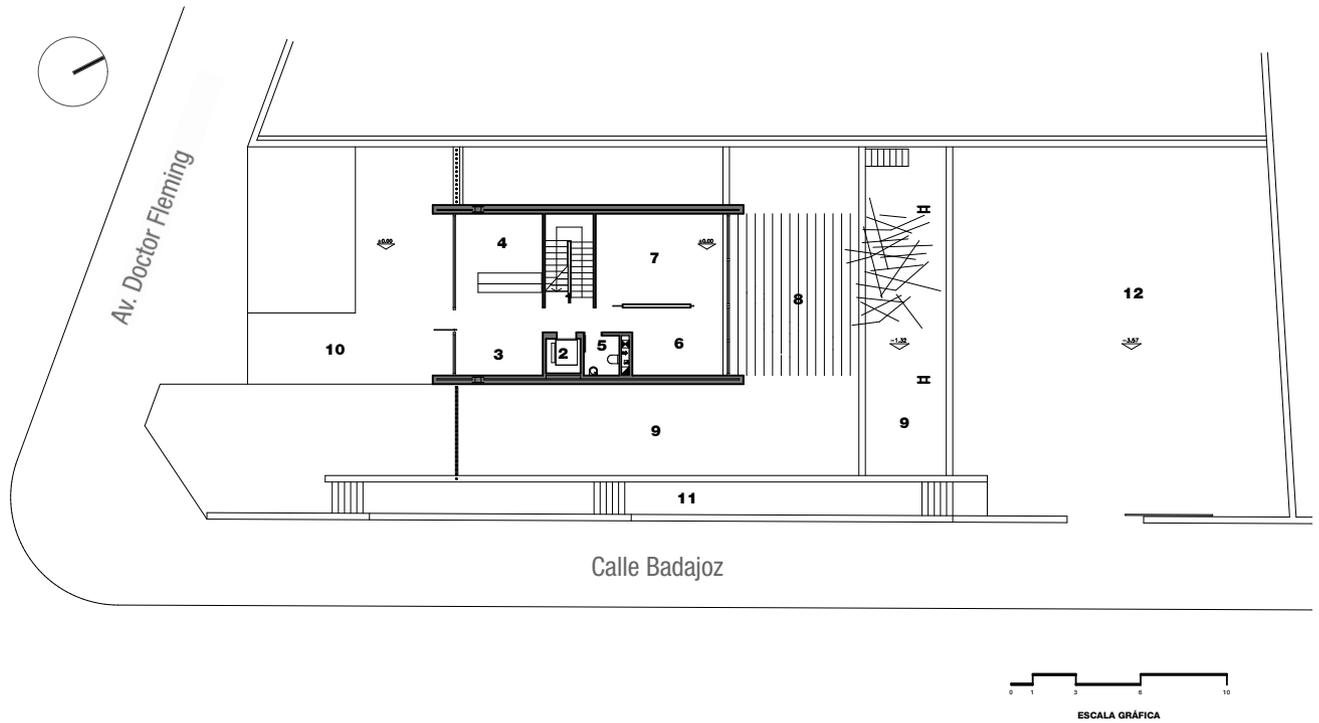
Análisis funcional de la planta baja del Edificio de oficinas Benigar.
